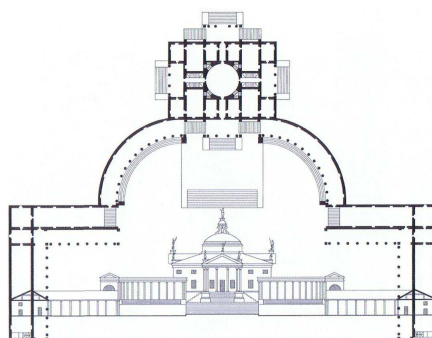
Meledo, Villa Trissino, Planta e Alçado. (Palladio, 1570)
